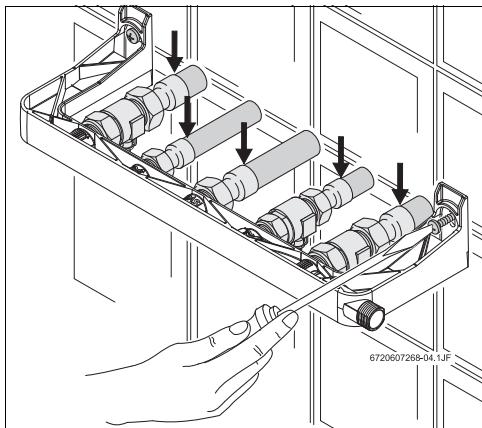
Fijación de la preplantilla y soldadura de los tubos
